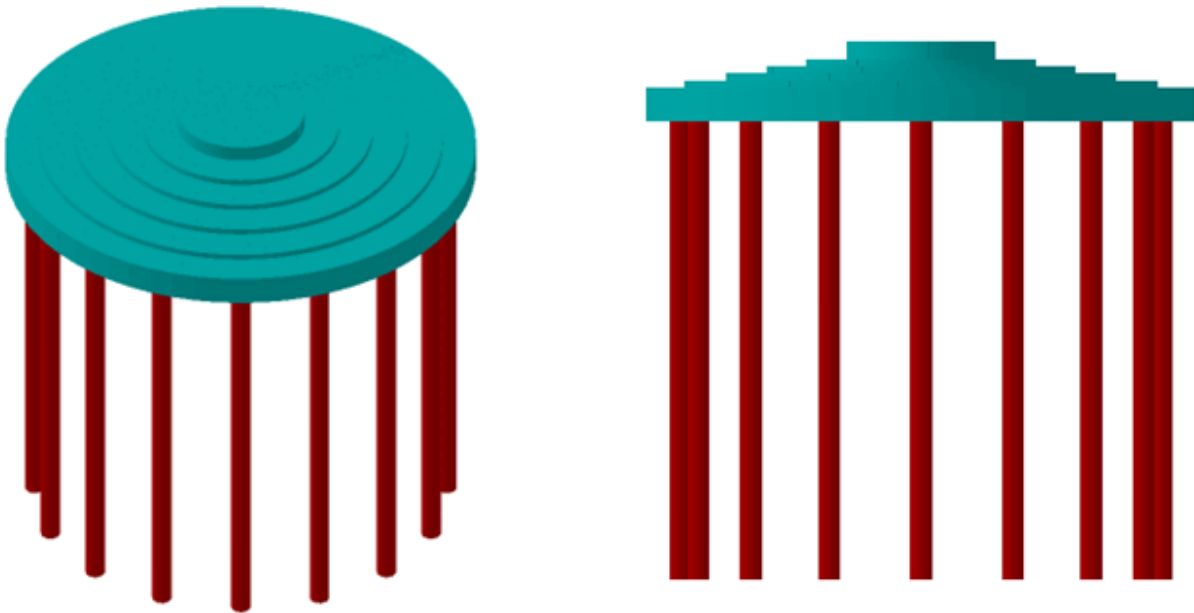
Vista 3D e vista XZ fondazione tipo.
